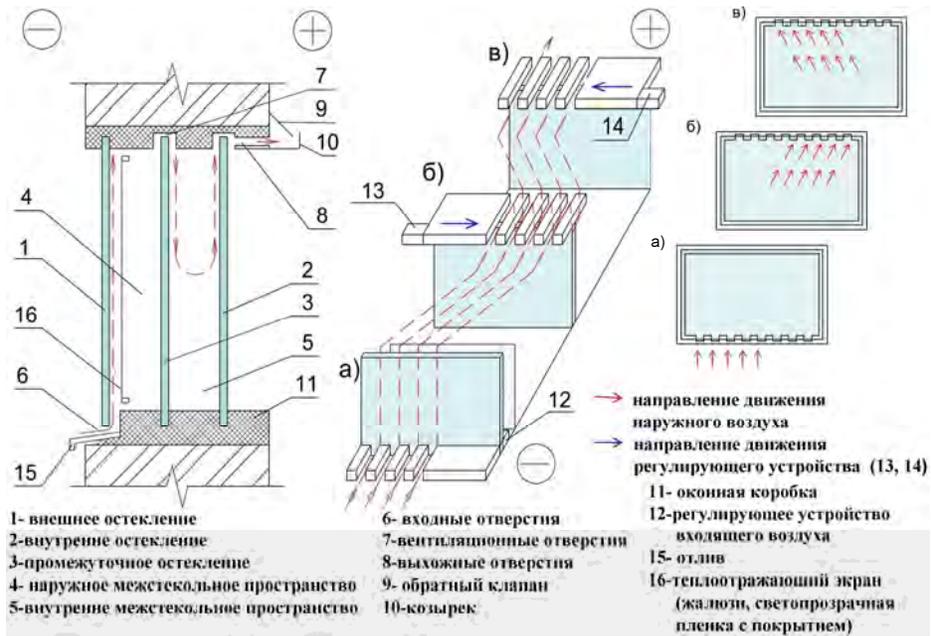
Использование светопрозрачных конструкций при разработке САЭ
